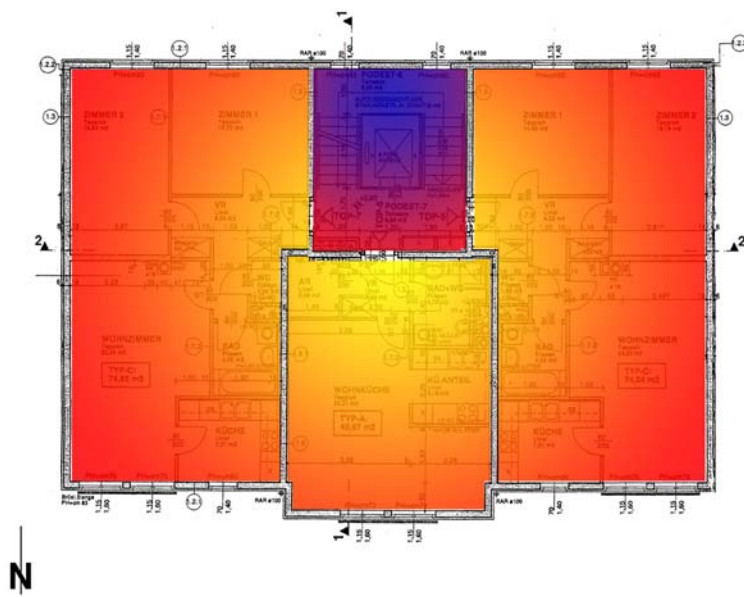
Grundriss MFH - beheizte und unbeheizte Zonen
